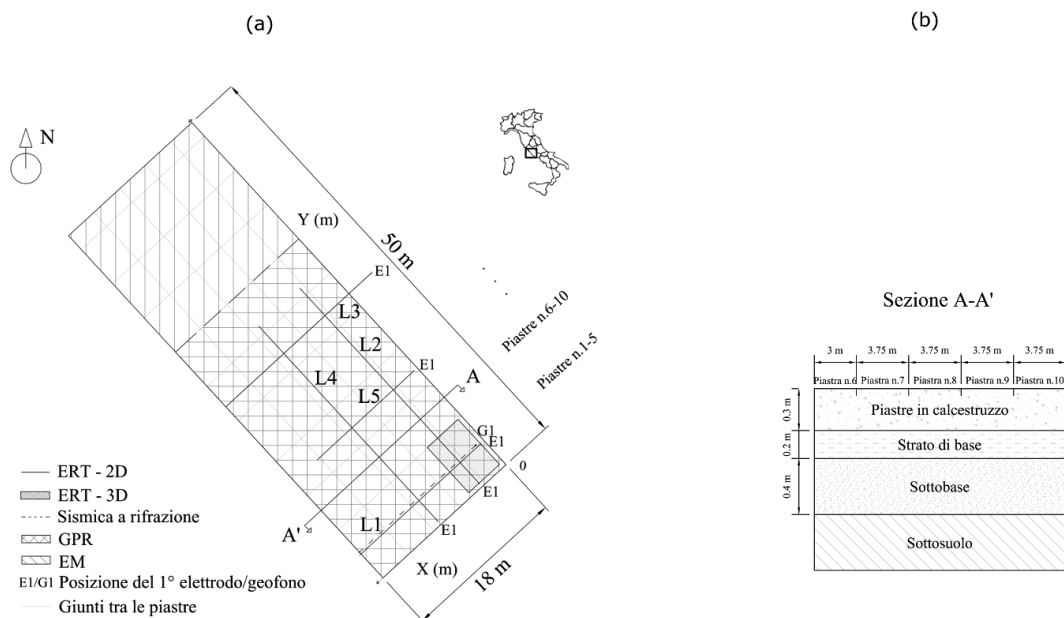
a) Planimetria dell'area indagata con indicazione delle indagini effettuate. b) Sezione A-A' della pavimentazione aeroportuale.
